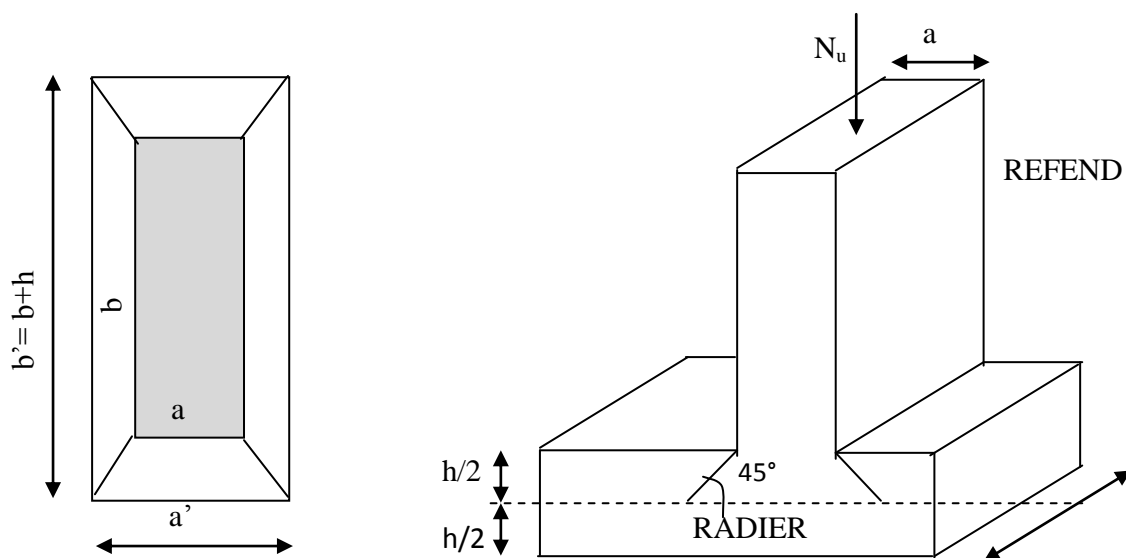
Périmètre utile des voiles et des poteaux.
